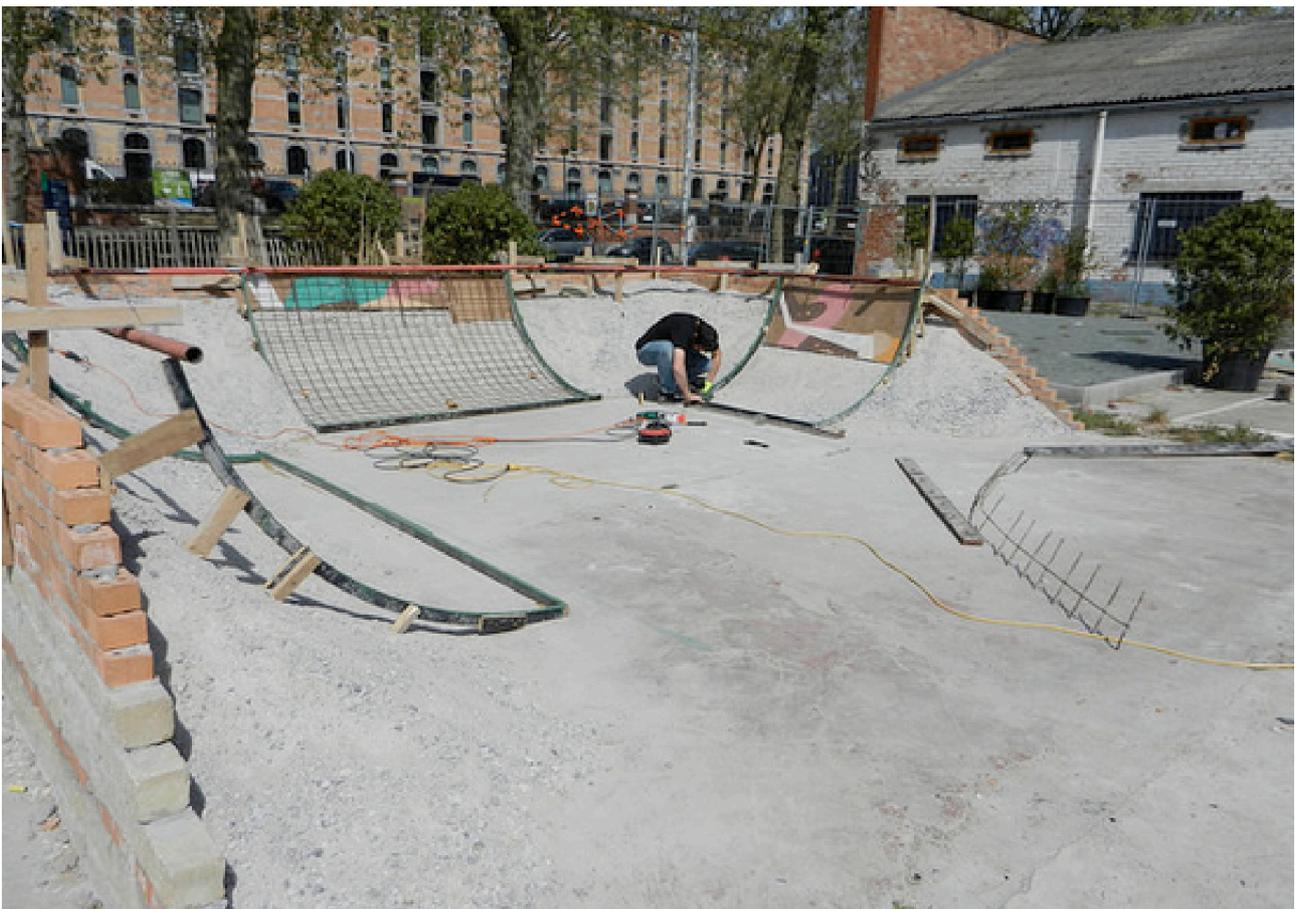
construction d'un skatepark par les jeunes (photo Toestand)
